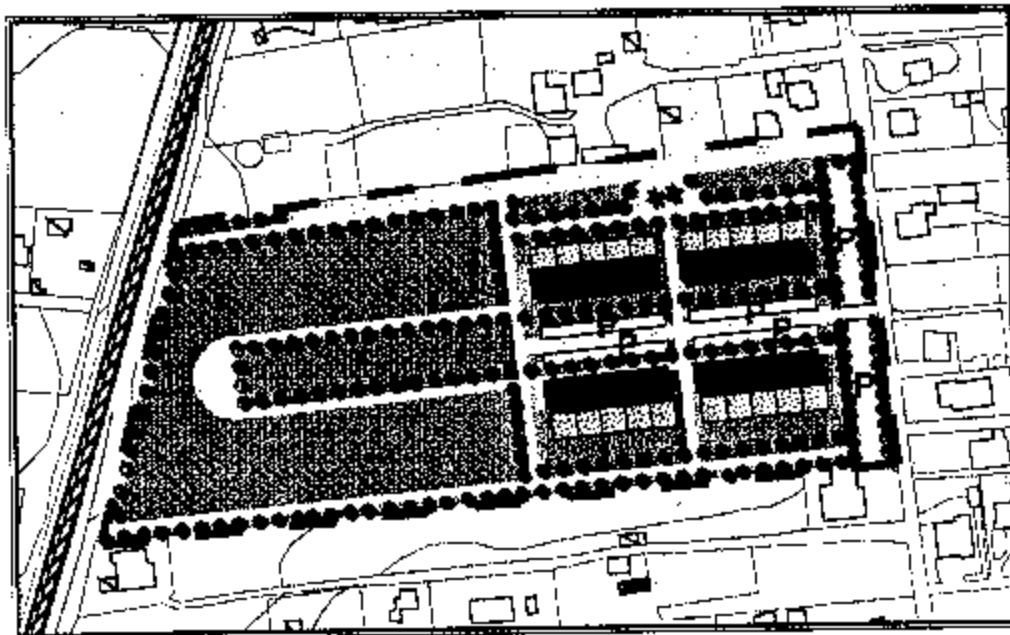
Planimetria del Comparto Tipo "C2" - Stato di Progetto
